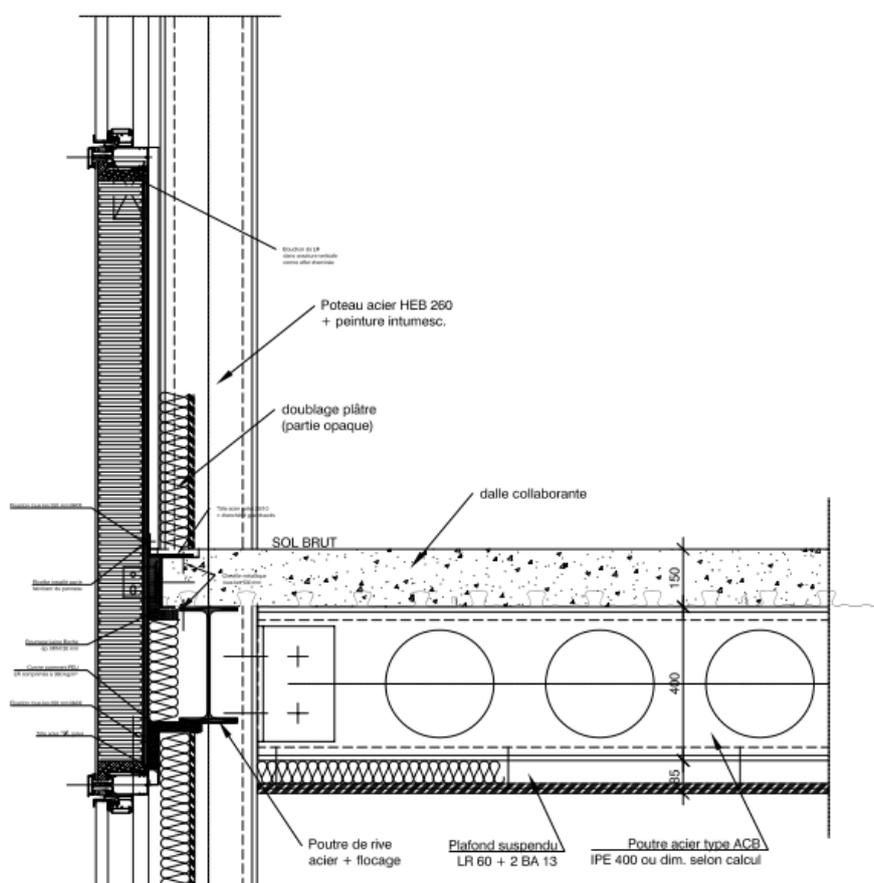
Schéma en coupe des planchers du bâtiment mixte optimisé
